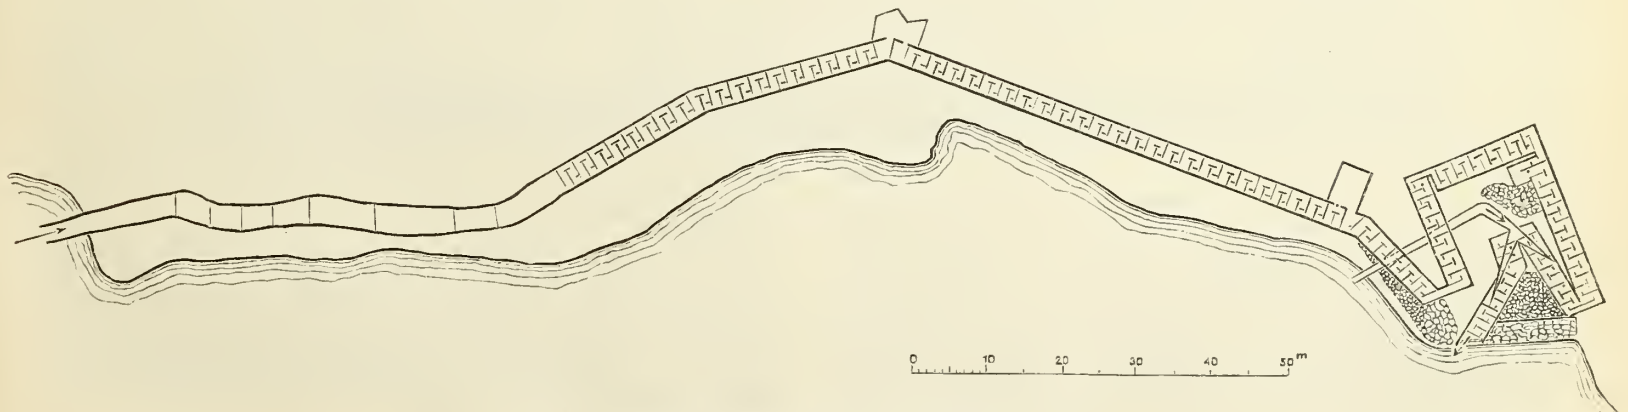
Fischpafs am Rukanfall. Grundriss. Mafsstab 1:1000.
